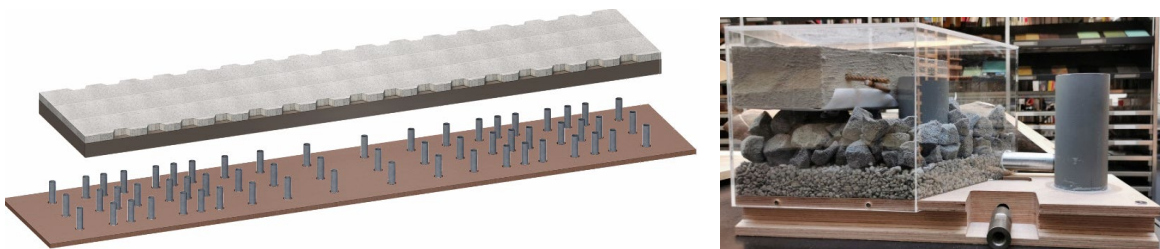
Holz-Beton-Verbunddecke mit Buchenplatten und Stahlrohren für die Verbindung zwischen Beton und Holz
